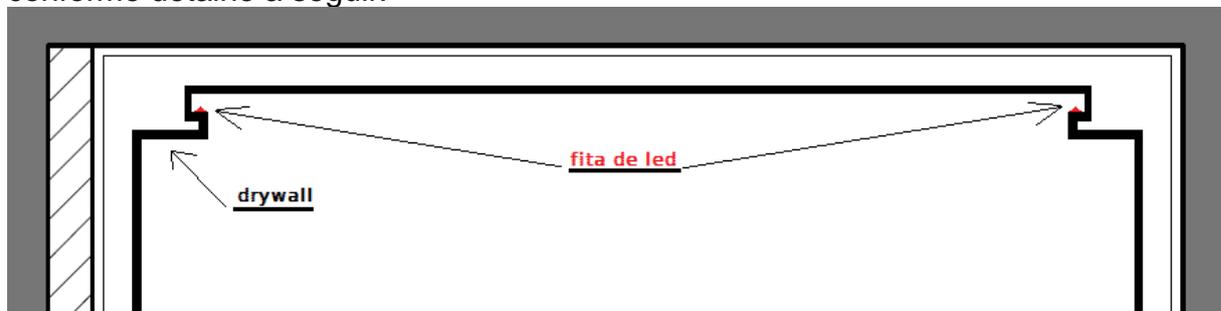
Planta baixa - Detalhe no drywall com reentrância para esconder fita de led
